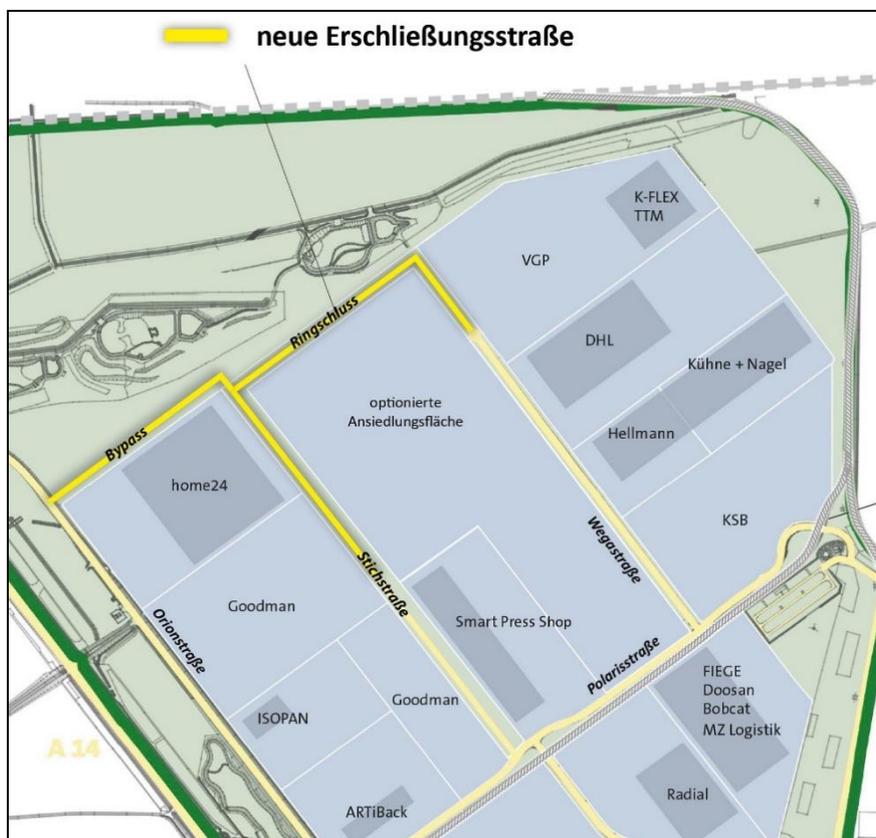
Verkehrskonzept, Stork Plan & Control GmbH, Planungsbüro DNR
